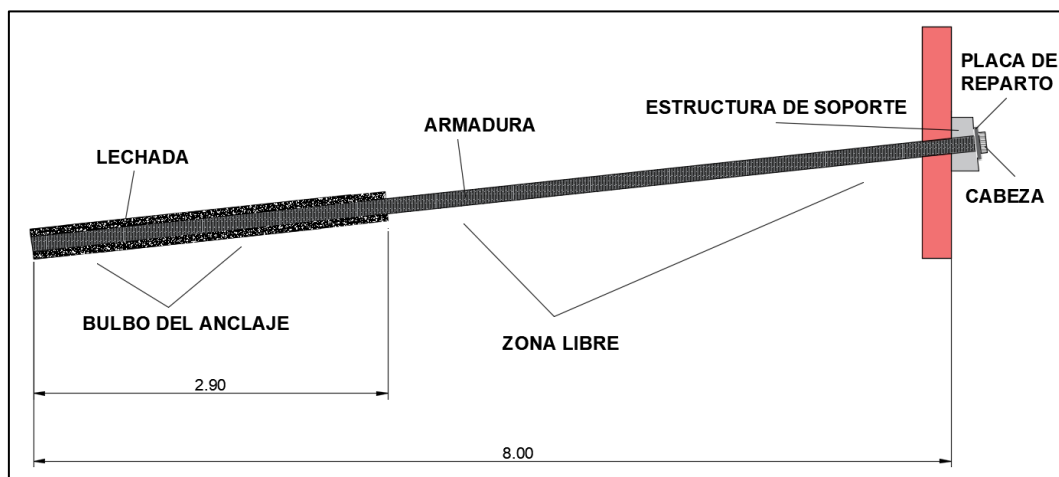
Esquema en detalle del anclaje pasivo con barras de 32 mm. Fuente: Propia
